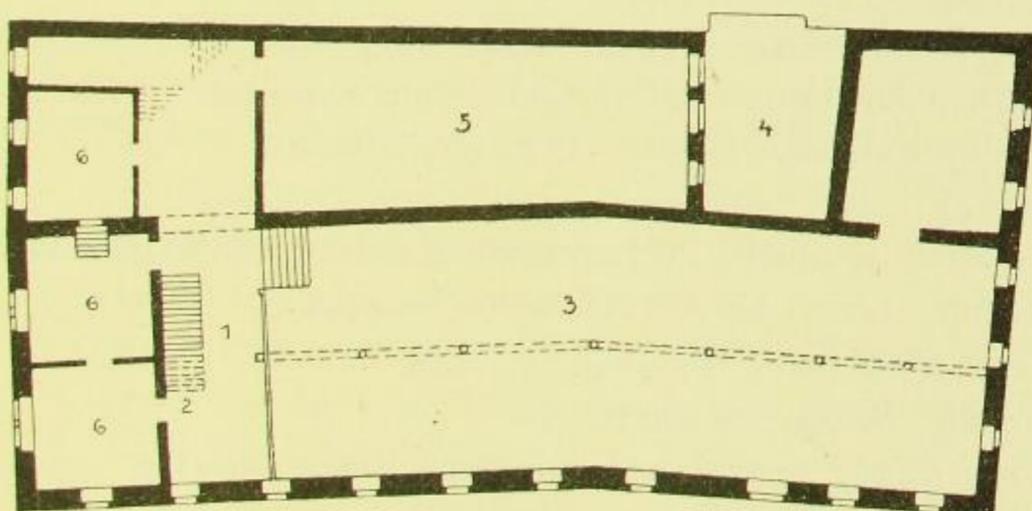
Grundriß des 1882 abgebrochenen Gewandhauses. Obergeschöß.
